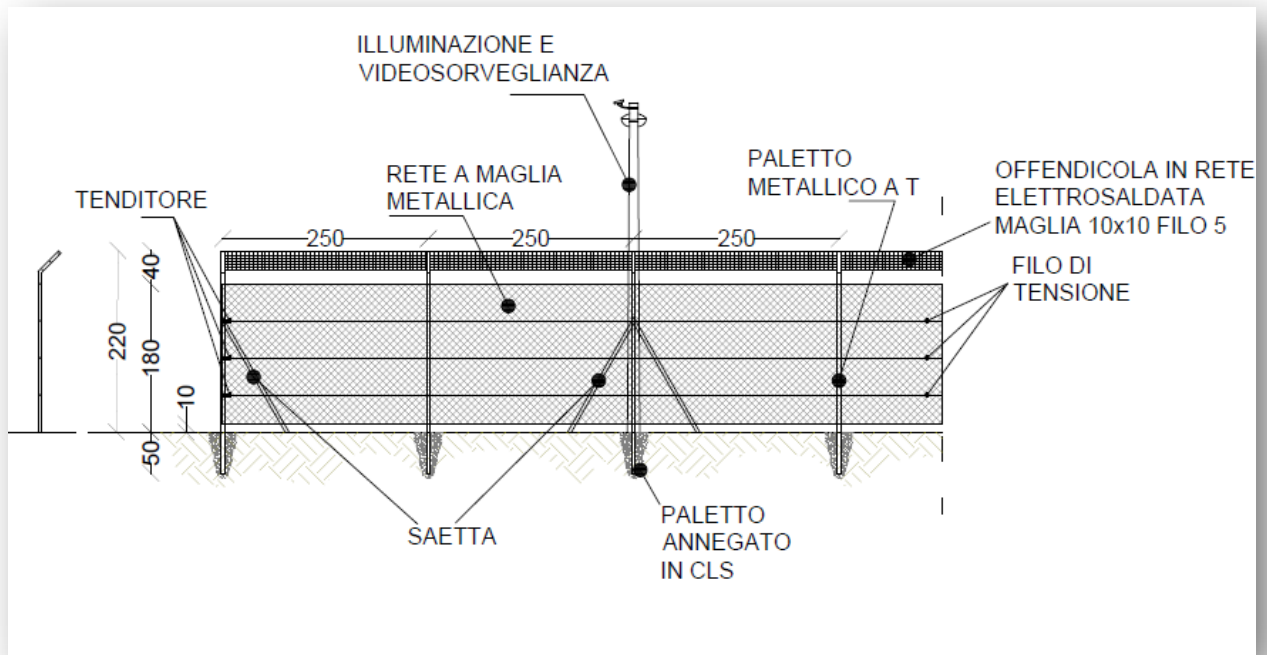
Estratto elaborato A.12.c.1 – Recinzione tipo impianto
